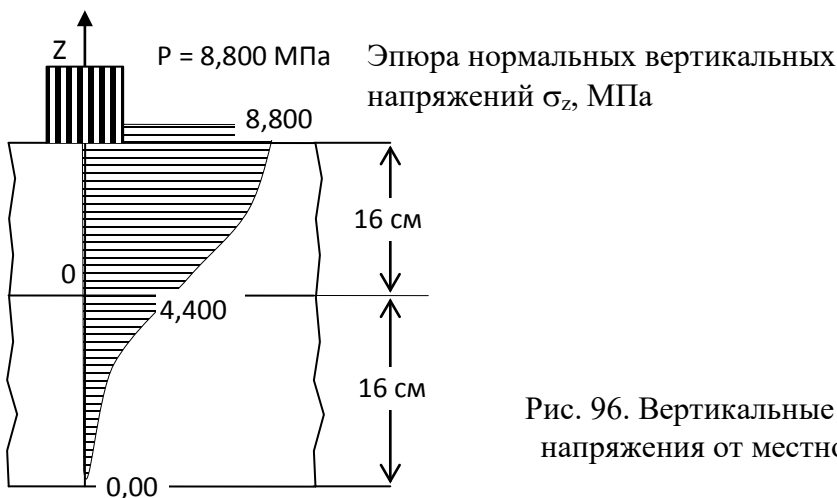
Вертикальные нормальные напряжения от местной нагрузки
